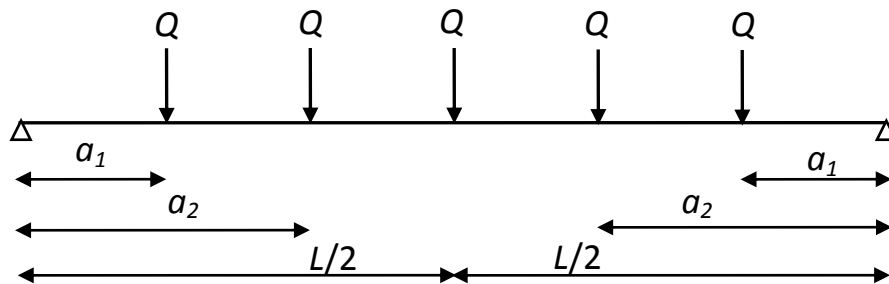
Poutre à âme pleine équivalente à la poutre en treillis
